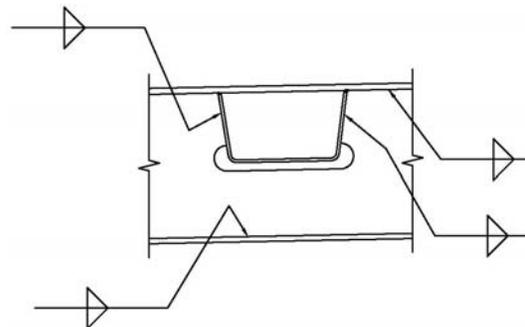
Détail de l'intersection de la poutre transversale en élévation et auge trapézoïdale
